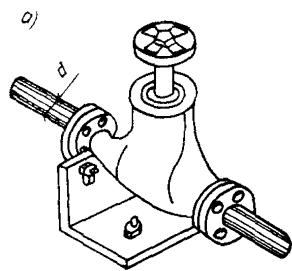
Крепление арматуры с помощью опоры для труб диаметром:
